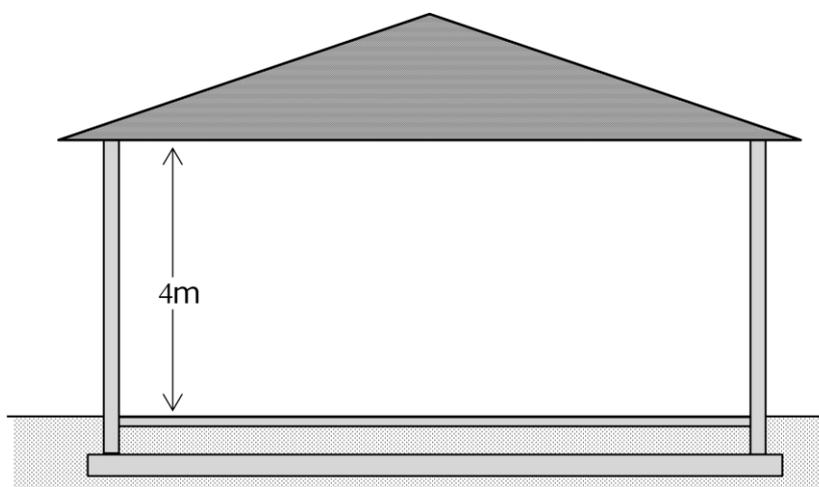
exemple d'un bâtiment de type 5(c)m
